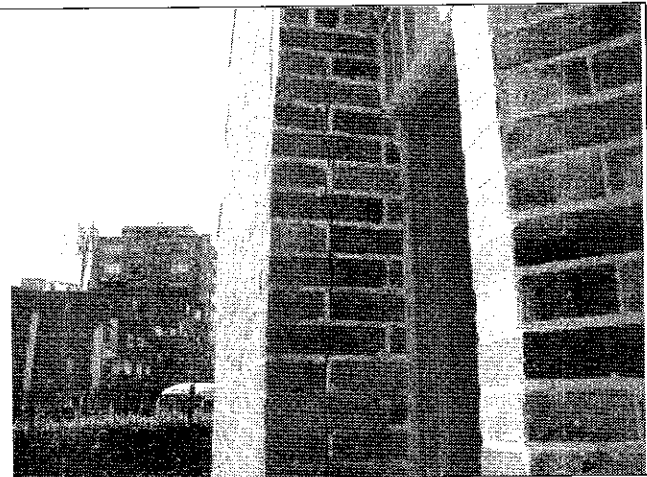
Detalle de la fachada del predio donde se presenta el desprendimiento de fachada.
